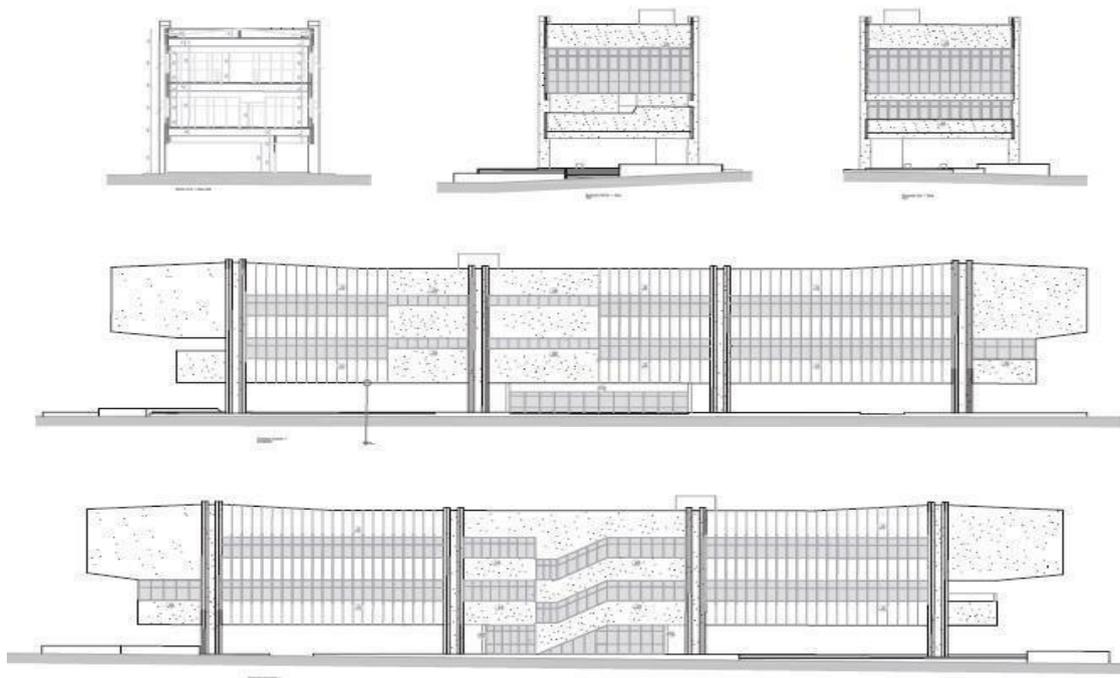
Corte Transversal e Fachadas do NPD/UFC Arq.Nearco Araujo.
